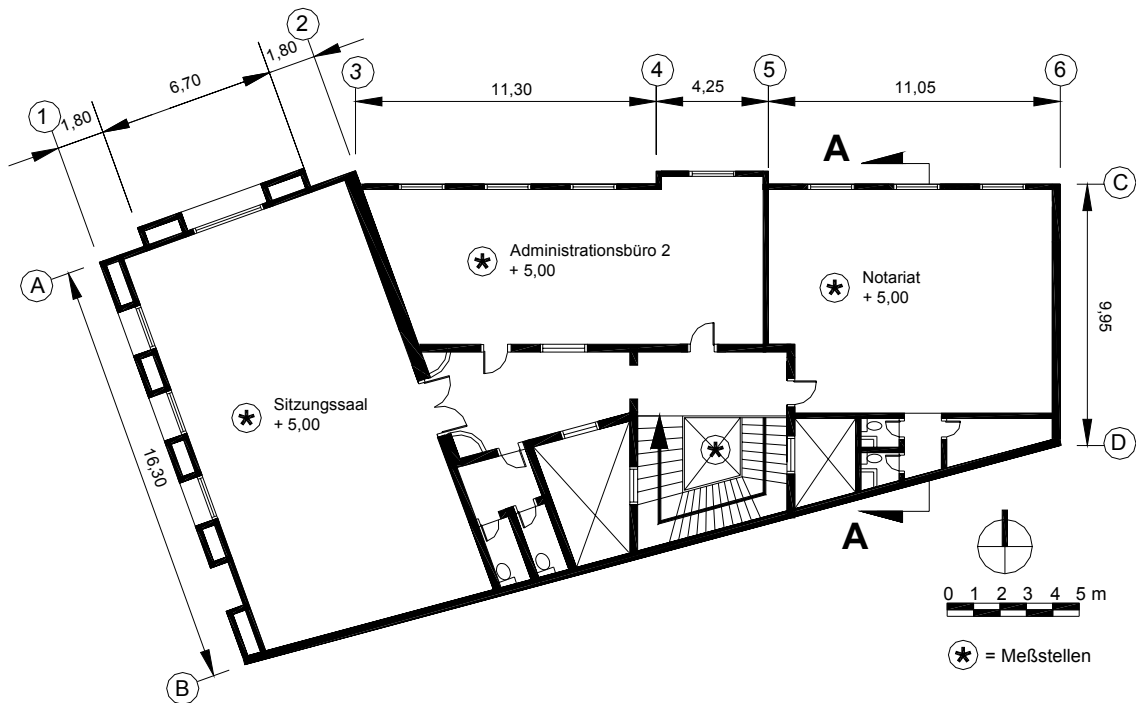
Grundriss 1. Obergeschoss von Gebäude B3
